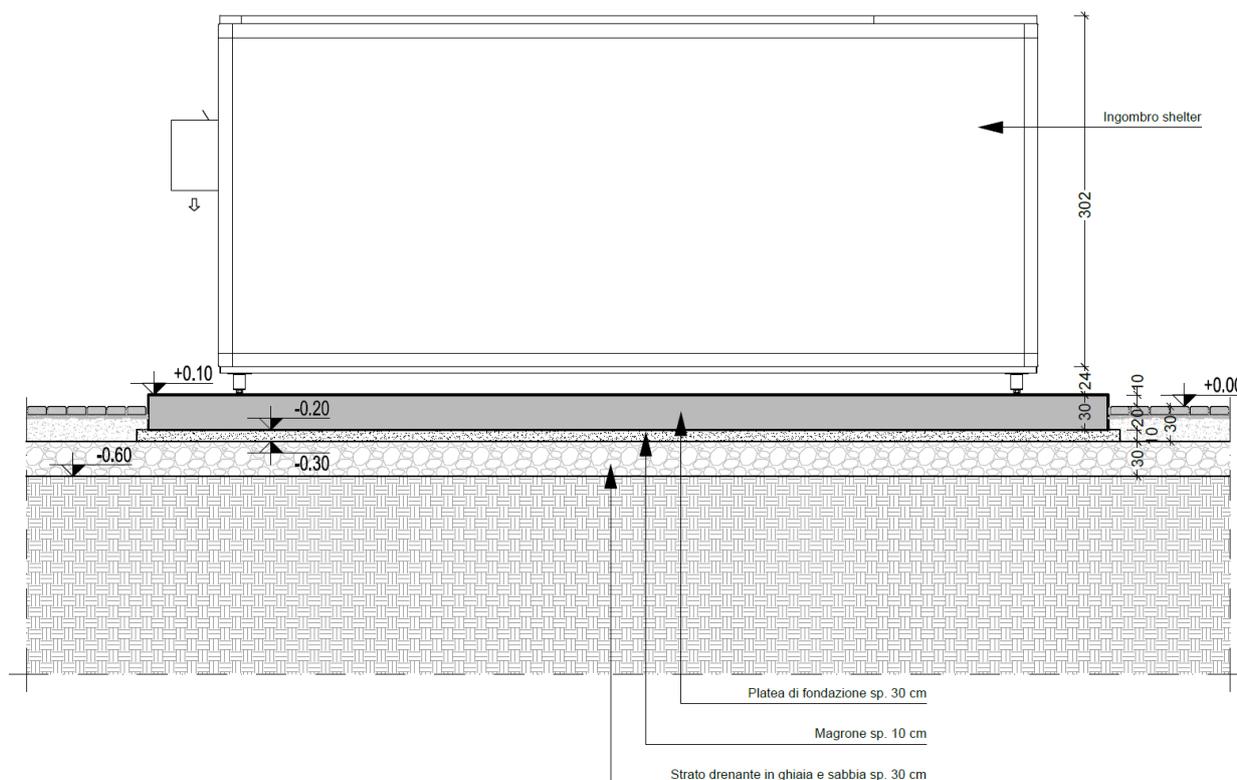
Sezione tipo basamento fondazione e Shelter per PPT
